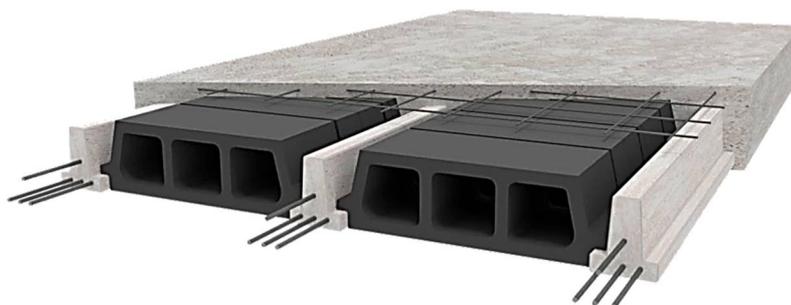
Схема перекрытий изготавливаемых из полуфабрикатов (железобетонная балка, межбалочные элементы заполнения)
